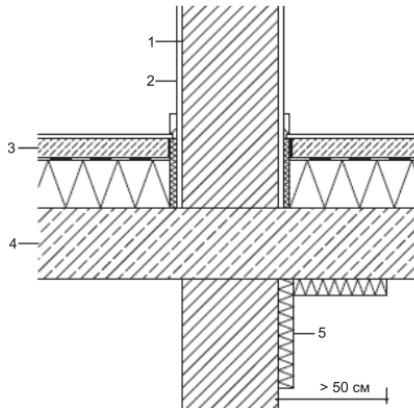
Теплоизоляция подвального перекрытия с верхней стороны, с одновременным устранением "теплового мостика" в области стыка с внутренней разделительной стеной: 1 — внутренняя стена;
